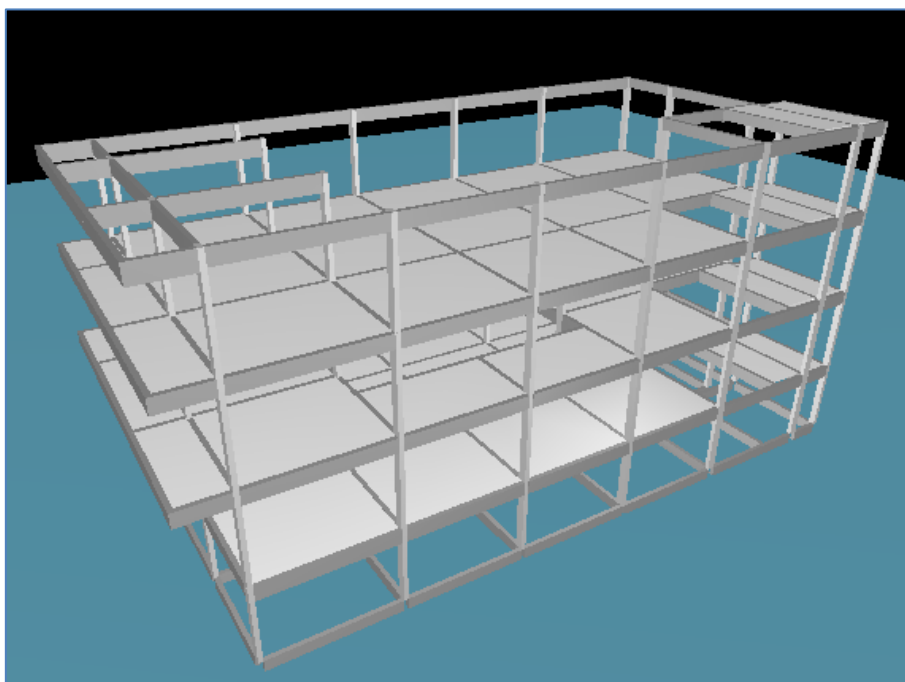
Modelo 3D: Estrutura em concreto armado (CAD/TQS).
